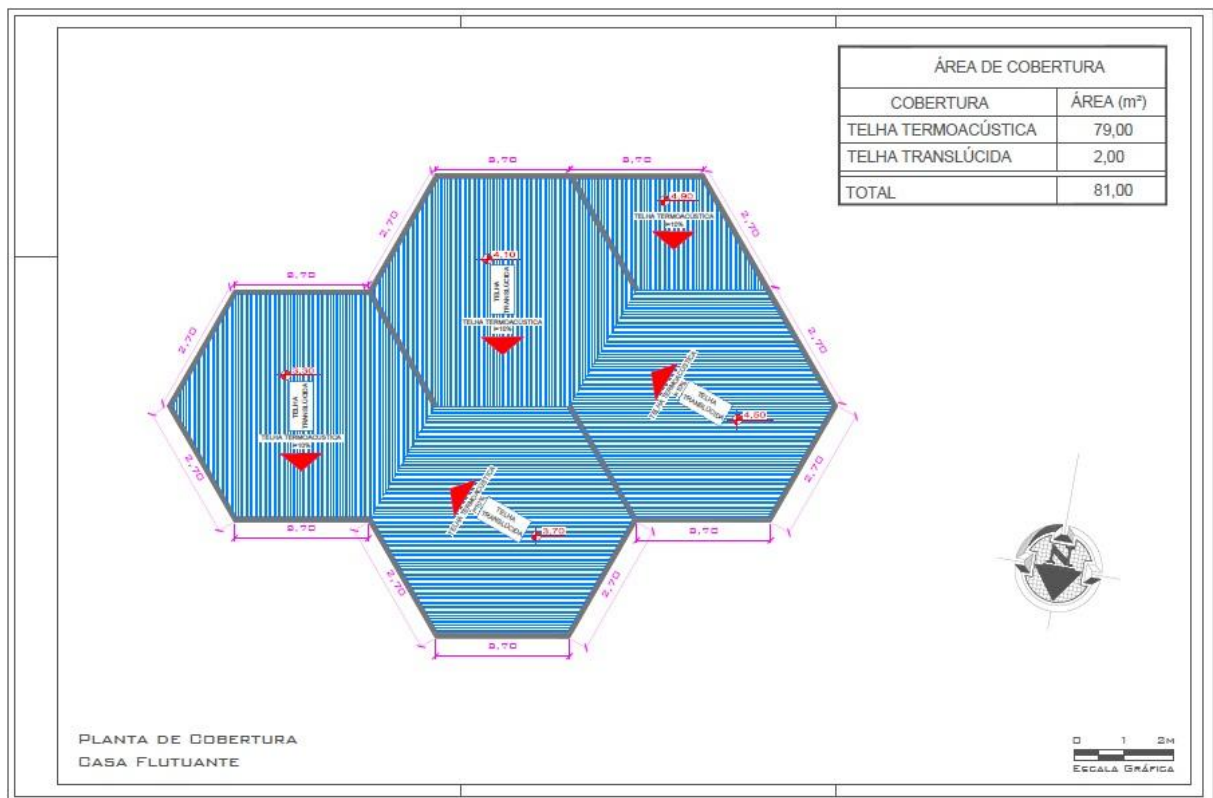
Planta de cobertura de unidade residencial tipo. Acervo do autor.
